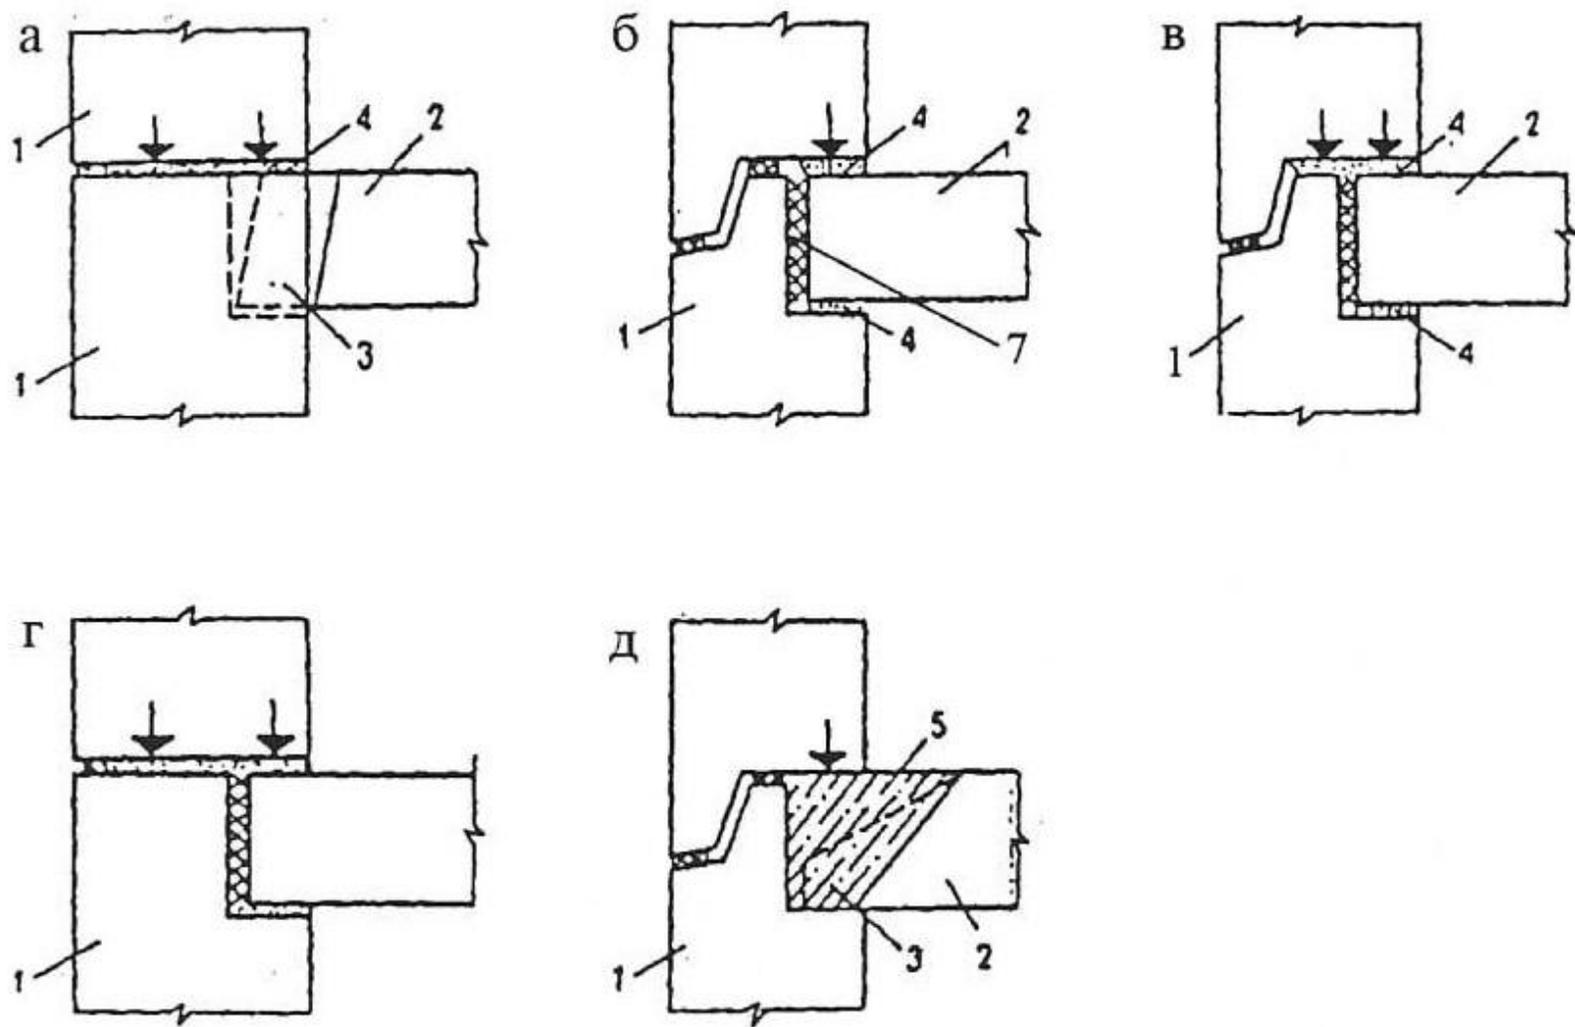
Горизонтальные стыки панелей несущих наружных стен и схемы передачи в них вертикальной нагрузки: а – контактный; б – платформенный; в – комбинированный профилированный; в – то же, плоский; д – монолитный; 1 – панель наружной стены; 2 – панель перекрытия; 3 – опорный "палец" панели перекрытия; 4 – цементный раствор; 5 – бетон замоноличивания; 6 – упругая прокладка; 7 – утепляющий вкладыш
